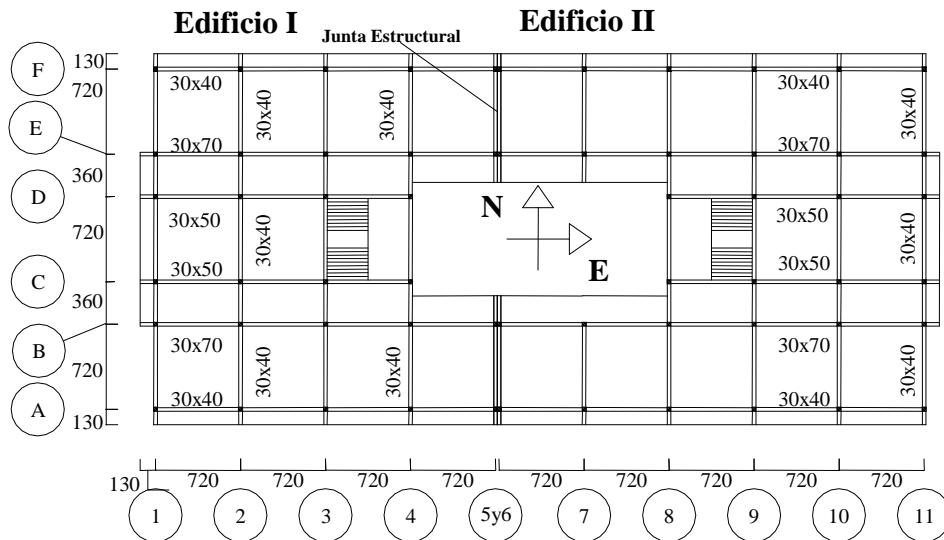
Planta del primer nivel del Liceo RMC (Dimensiones en cm.)
